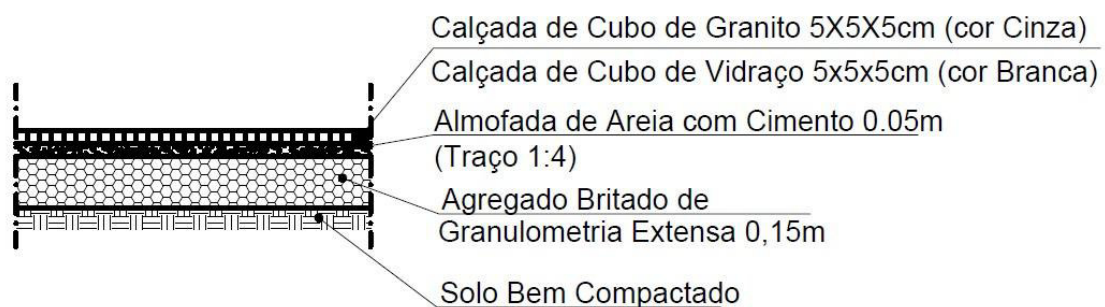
Pormenor construtivo do pavimento pedonal [76]
